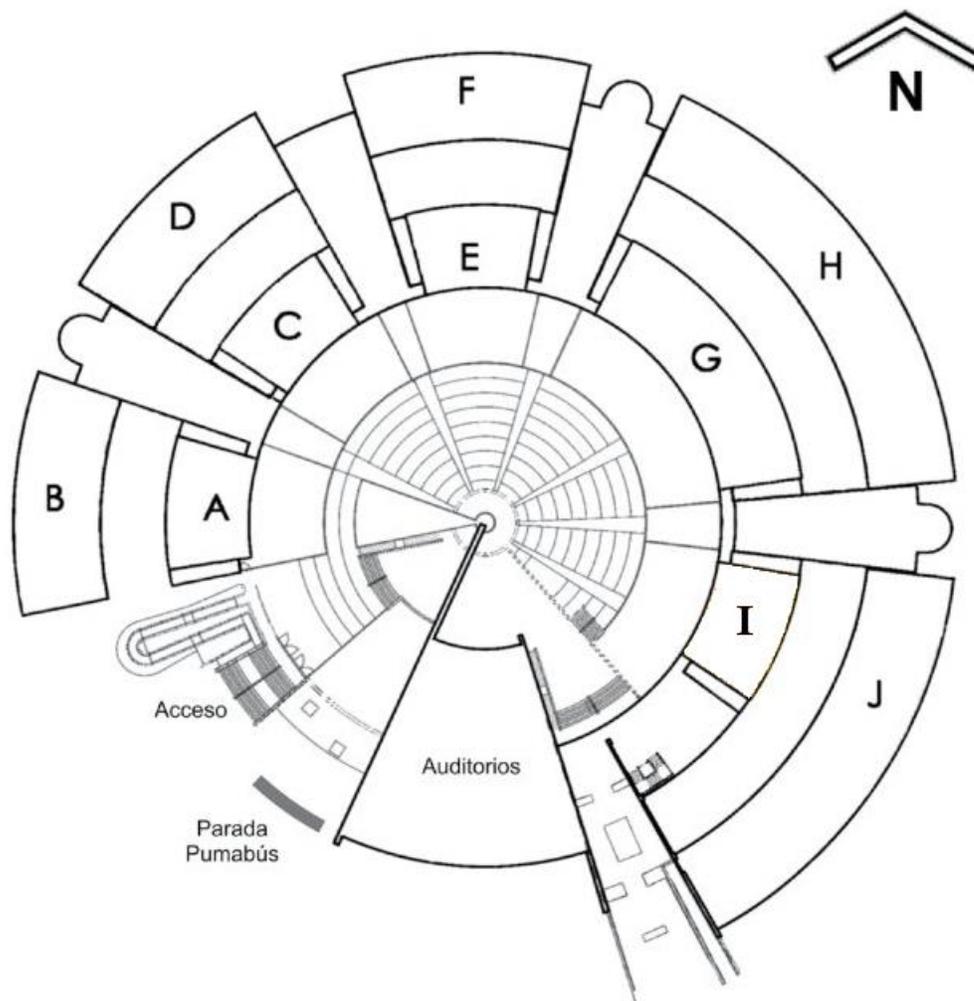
Planta arquitectónica de la Unidad de Posgrado
